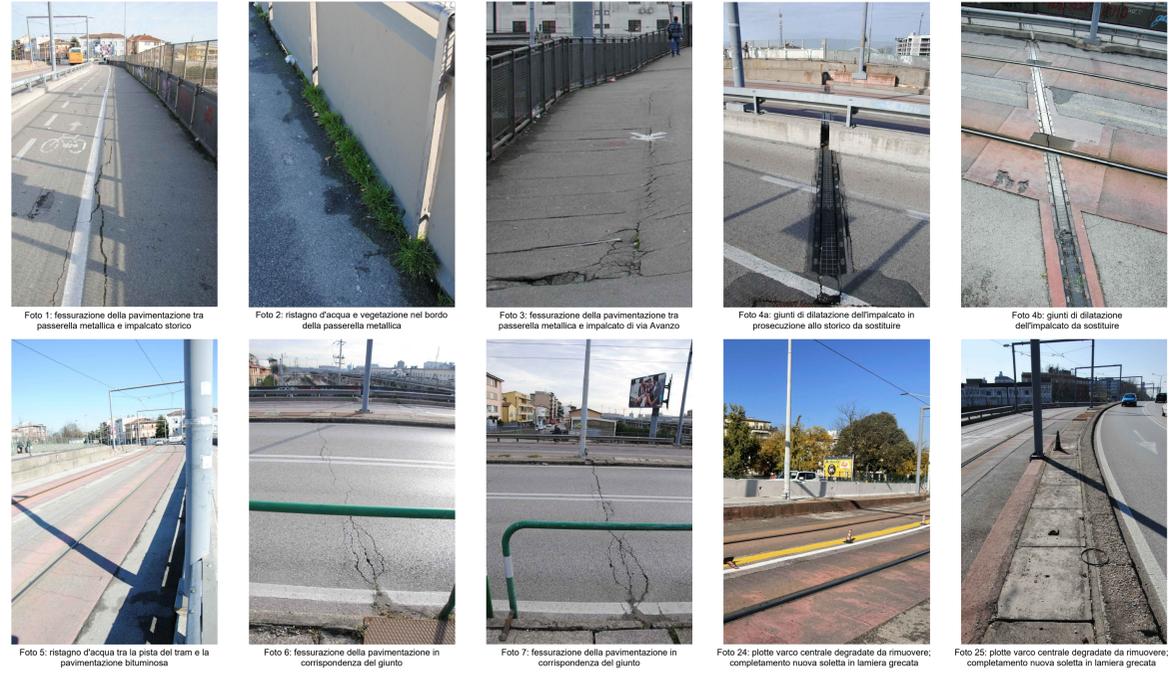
fessurazione della pavimentazione tra passerella metallica e impalcato storico
